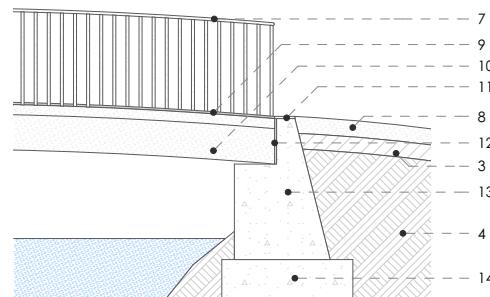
DETALLES ZONA 2 Y ZONA 3
